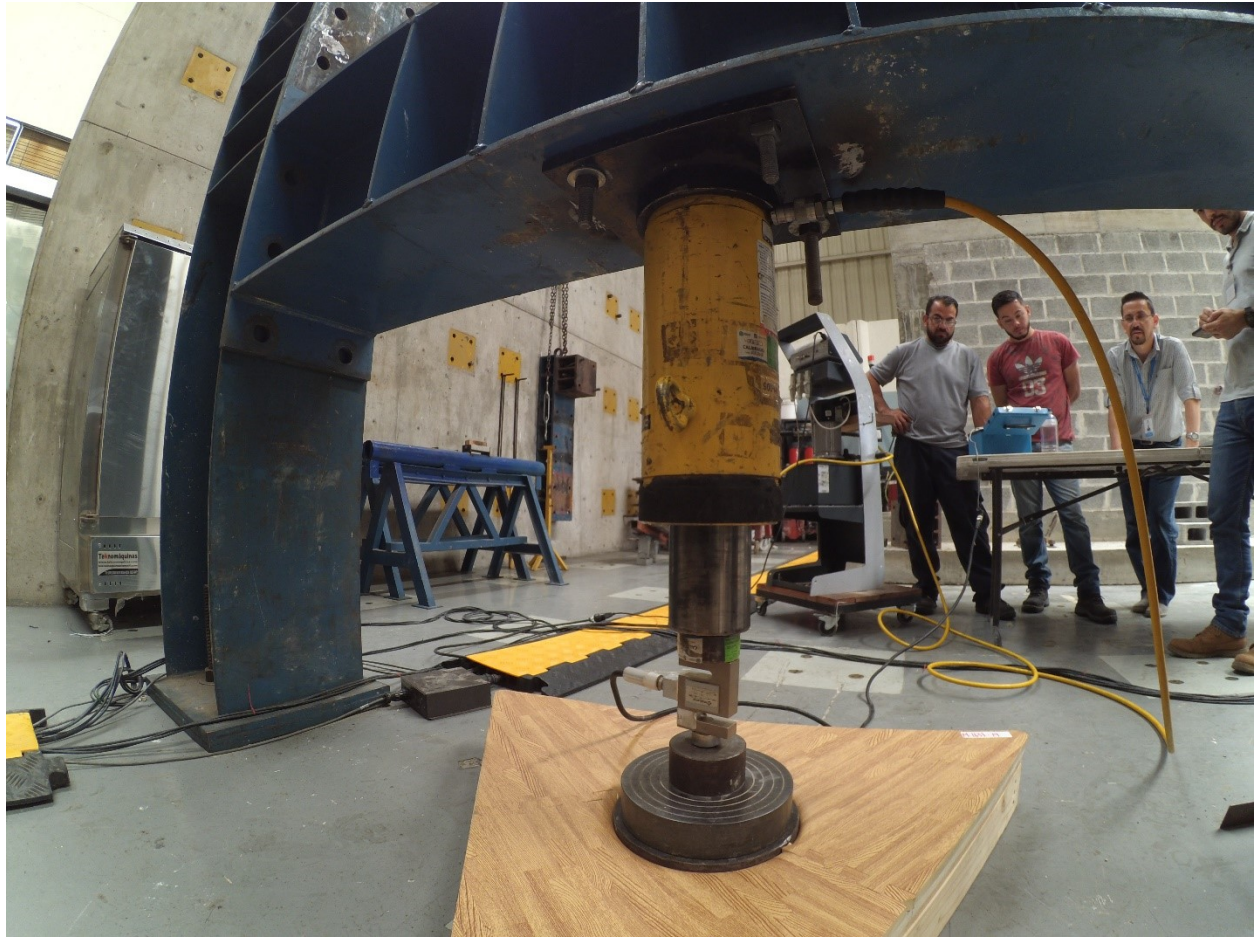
Vista inferior en la prueba de carga estructural al módulo de piso de la tipología B.<sup>337</sup>
